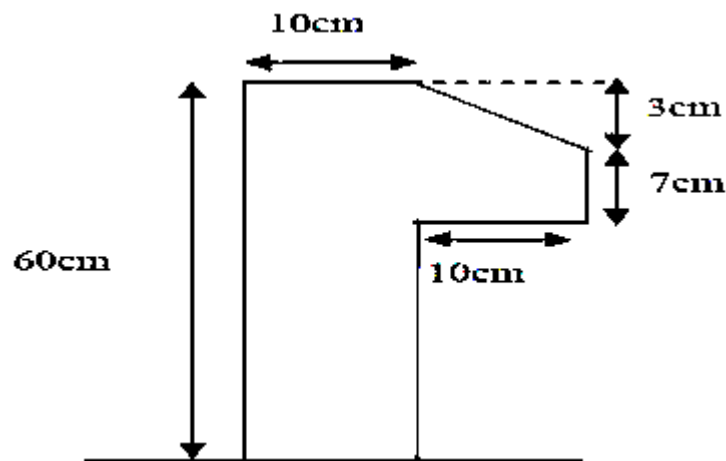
SECTION TRANSVERSALE DE L'ACROTERE
